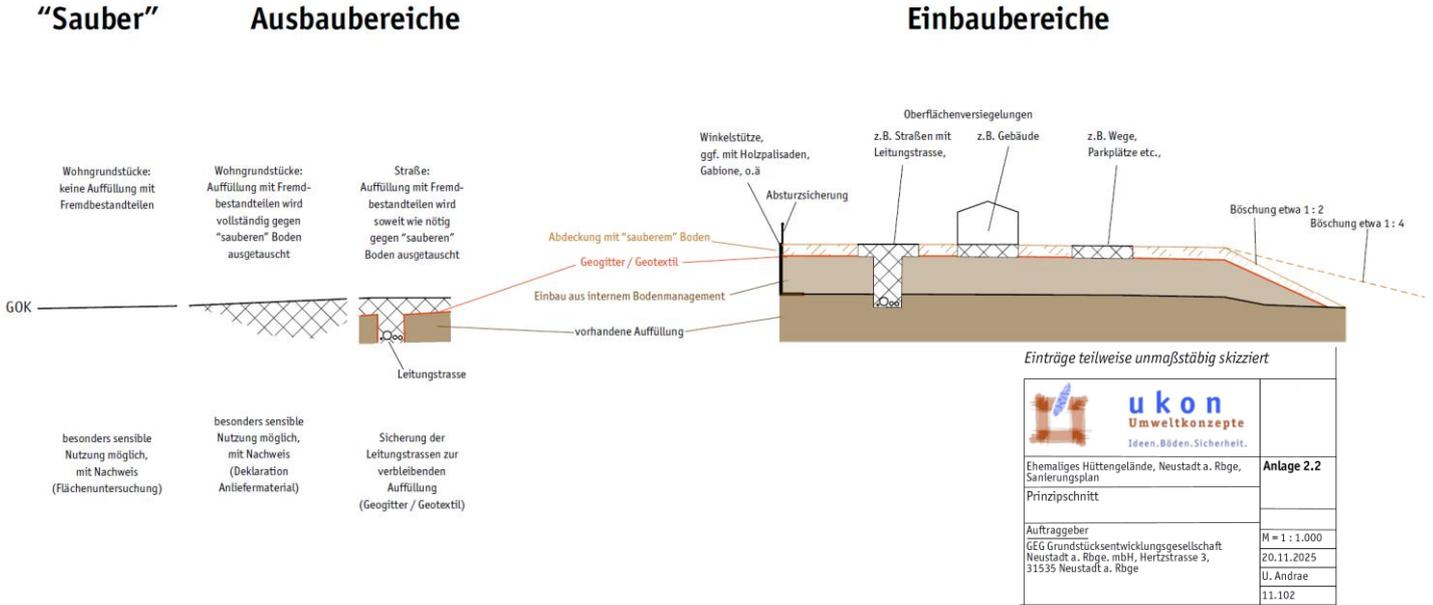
Prinzip der Bodensanierung mit dem Ausbau, der Entsorgung und dem Einbau von Bodenmassen, Anlage 2.2 (ukon 2026)
